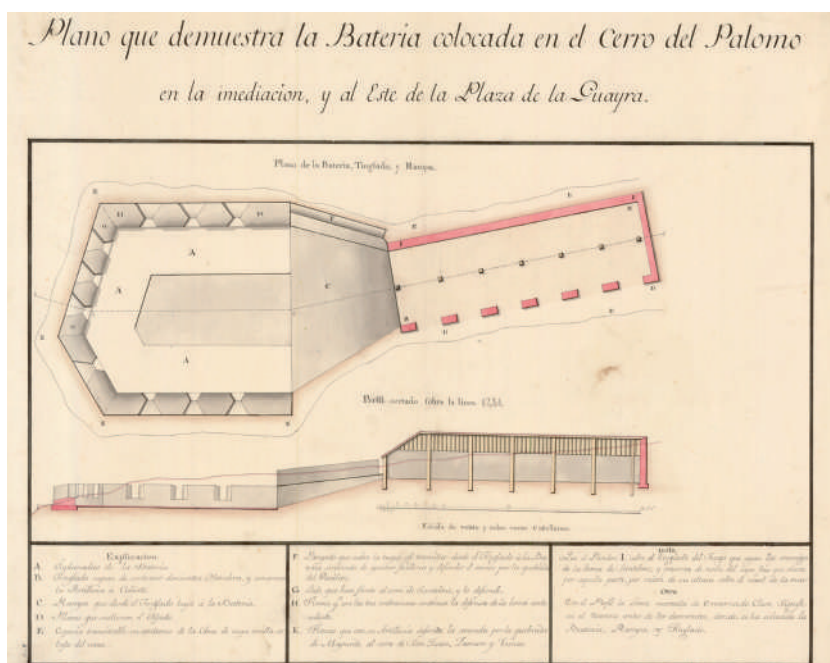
Planta de la batería El Palomo (s.a. [Atribuido a Juan Miguel Roncali]. 1792. «Plano que demuestra la batería colocada en el cerro del Palomo en la inmediación (sic) y al este de la Plaza de La Guaira». La Guaira, 1792. En ACEGCGEM, sign. Ar. j-T.8-C.1_56).
